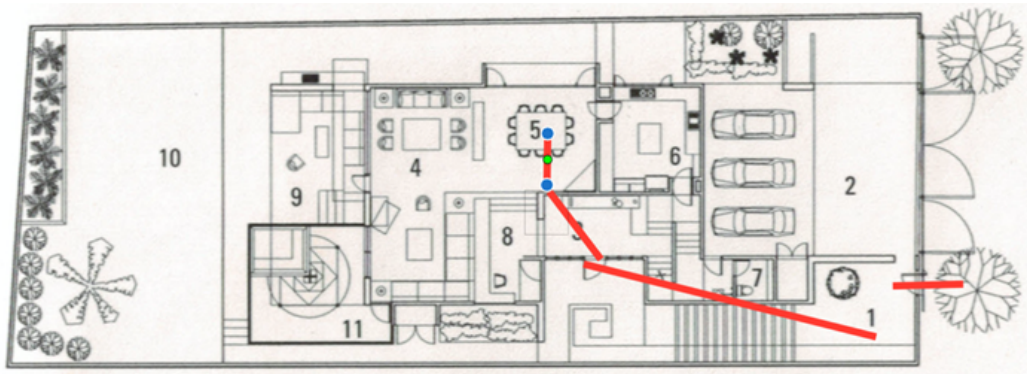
Recorrido marcado por el alumno Patricio, del grupo 302, sobre la planta arquitectónica de la casa Córdova, de Ricardo Legorreta.
